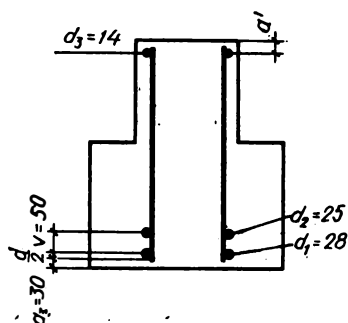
Схема армирования сечения ригеля в первом пролете.
